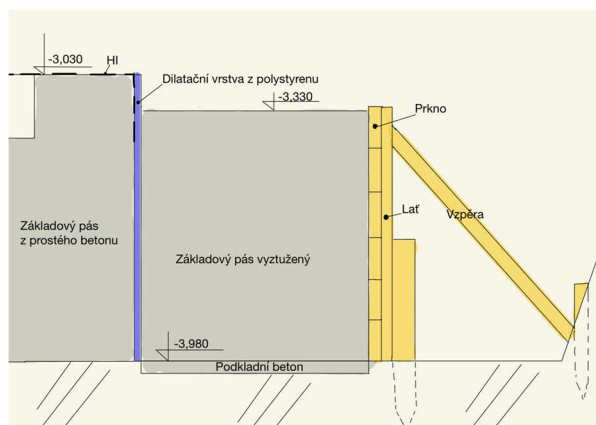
Zesílení základové konstrukce, zdroj: [vlastní]
